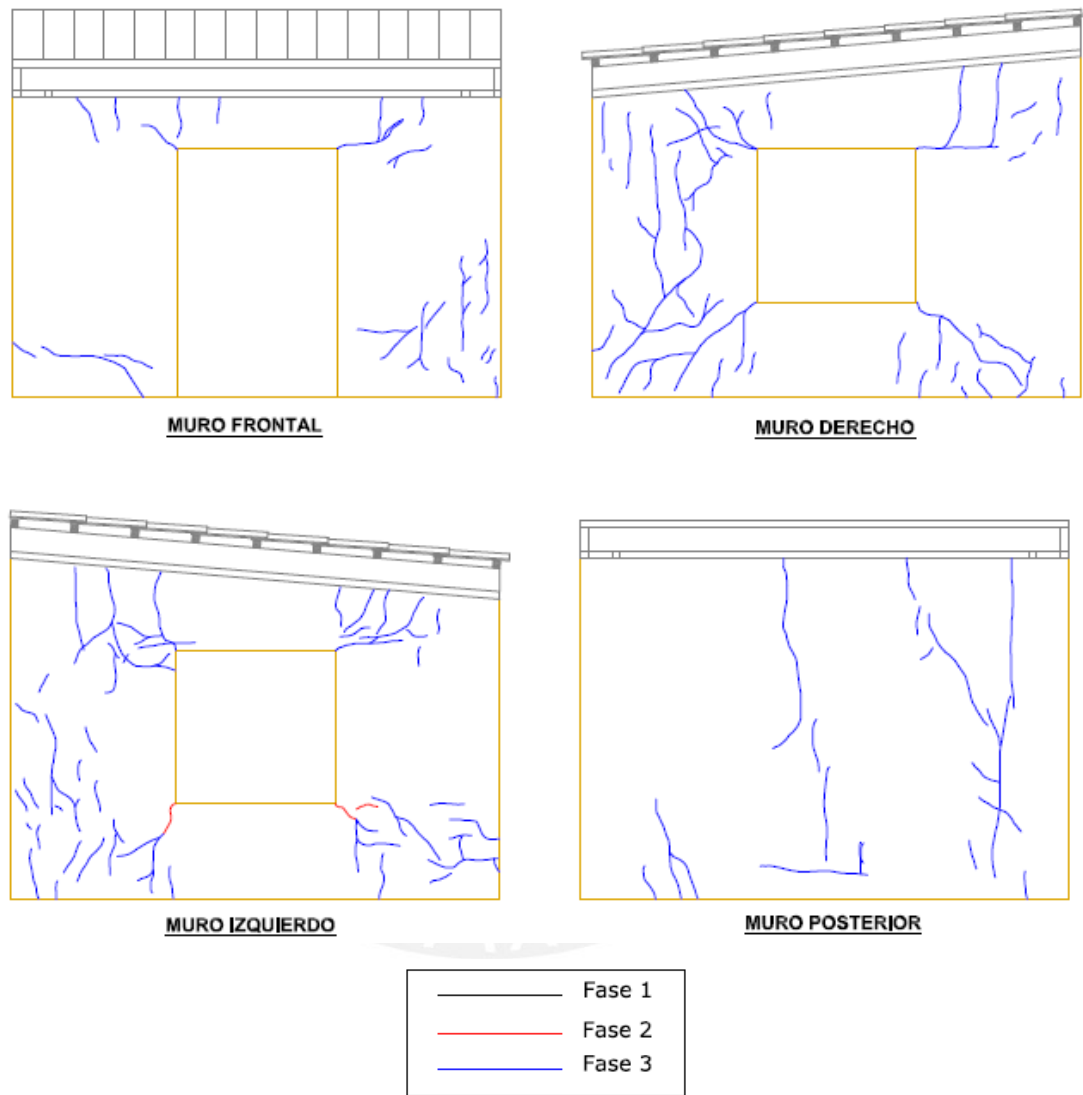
Fisuras en tarrajeo exterior – Módulo M100-T4100D
